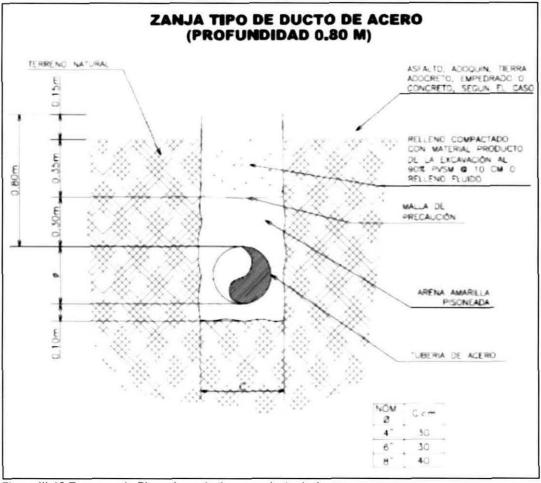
Esquema de Plano de zanja tipo para ducto de Acero
